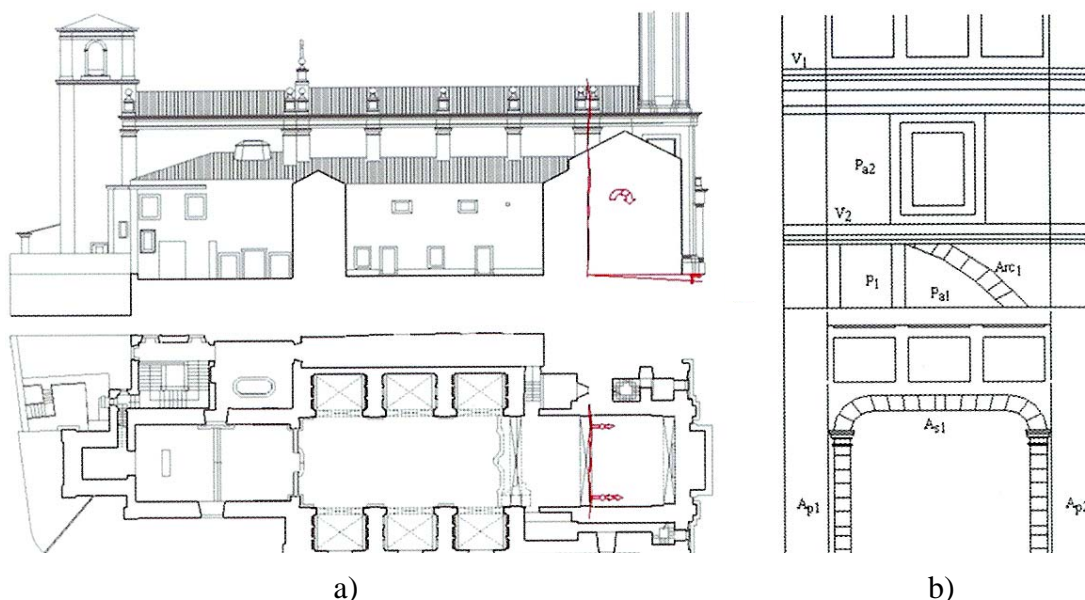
[4a]: a) Deformações associadas a movimento dos solos de fundação. Destaca-se a existência de uma rotação da estrutura
